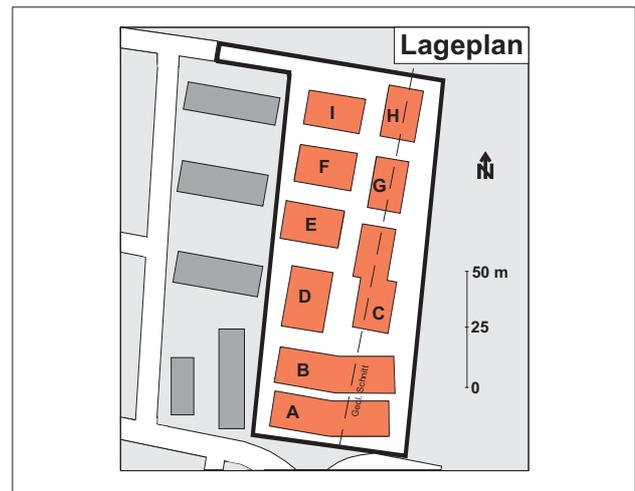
Lageplan der Wohnanlage. Hagelauer Consult, Walldorf.
